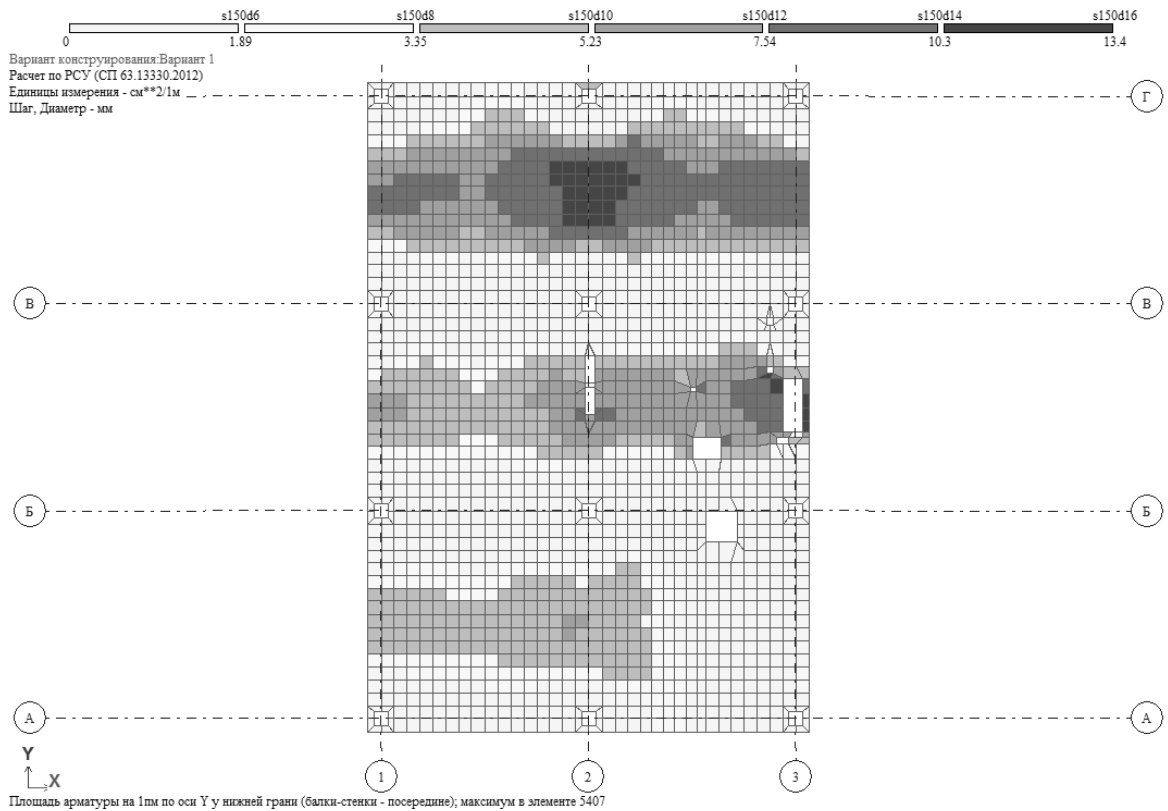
Армирование плит покрытия по оси Y у нижней грани
